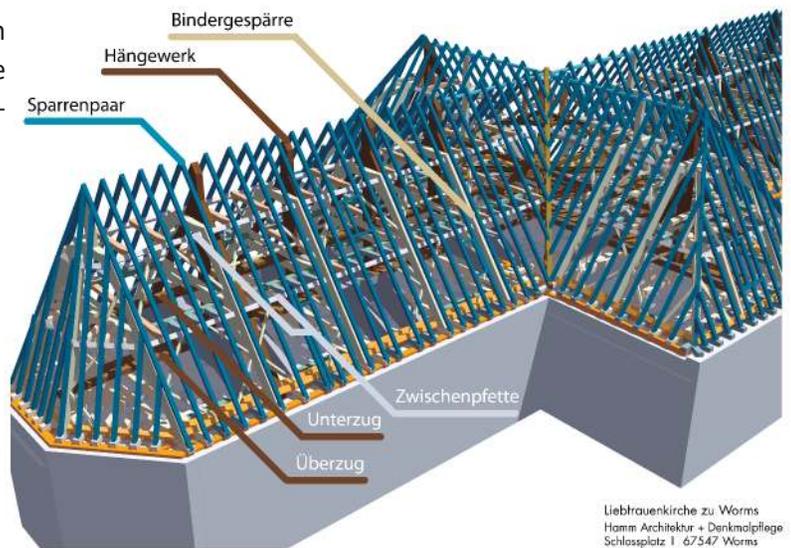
Aufbau des Dachgerüsts über dem Hauptschiff und dem Querhaus; 3D-Modell und Zeichnungen: Hamm Architektur + Denkmalpflege, Worms
